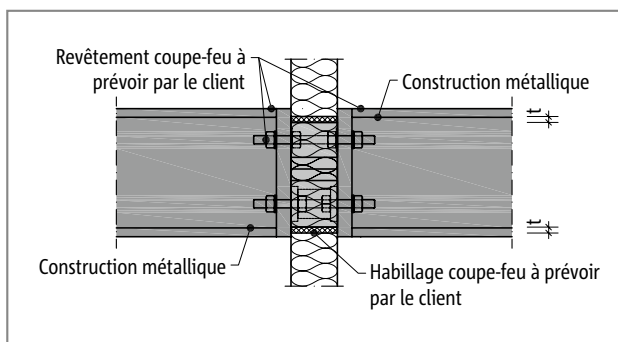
Protection incendie Schöck Isokorb® T type S : Bardage de protection incendie sur site - T type S, construction en acier avec revêtement de protection incendie ; coupe
